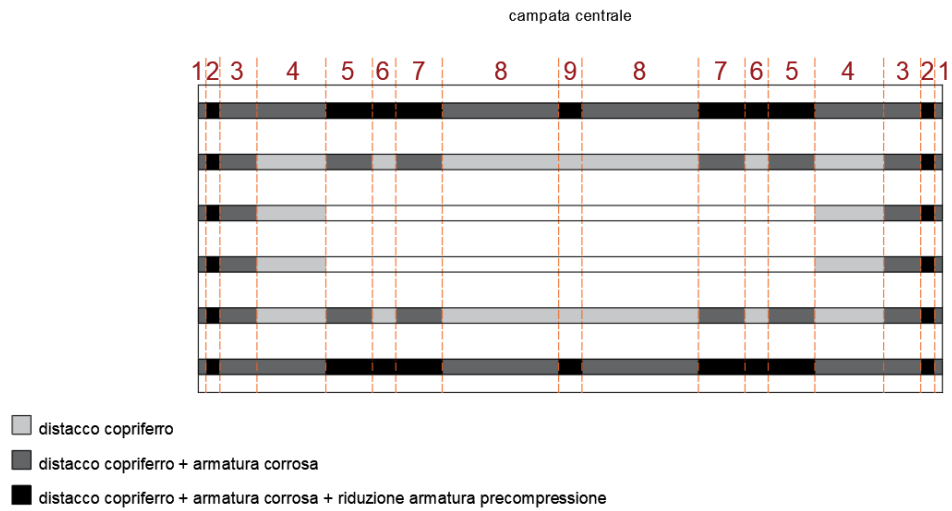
Ponte sul torrente Mavigliano, Caso I_ev4 schema deterioramento in pianta
